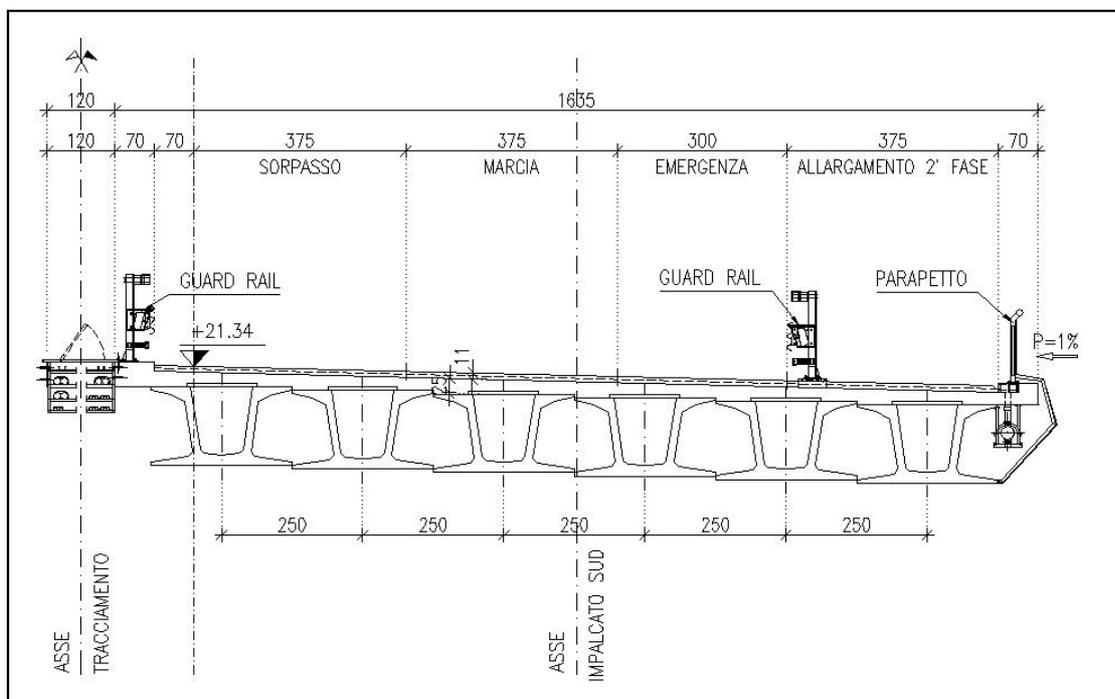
SEZIONE TIPICA IMPALCATO CON TRAVI IN CAP DI PD
